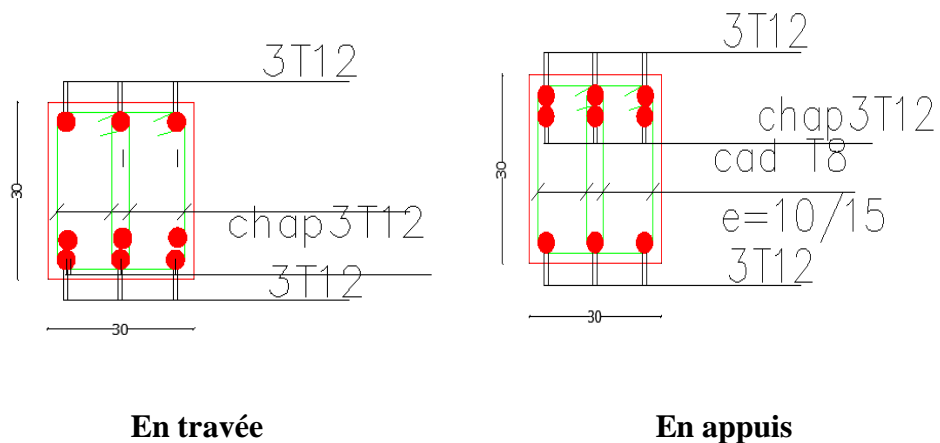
Schéma de ferraillage de poutre secondaire
